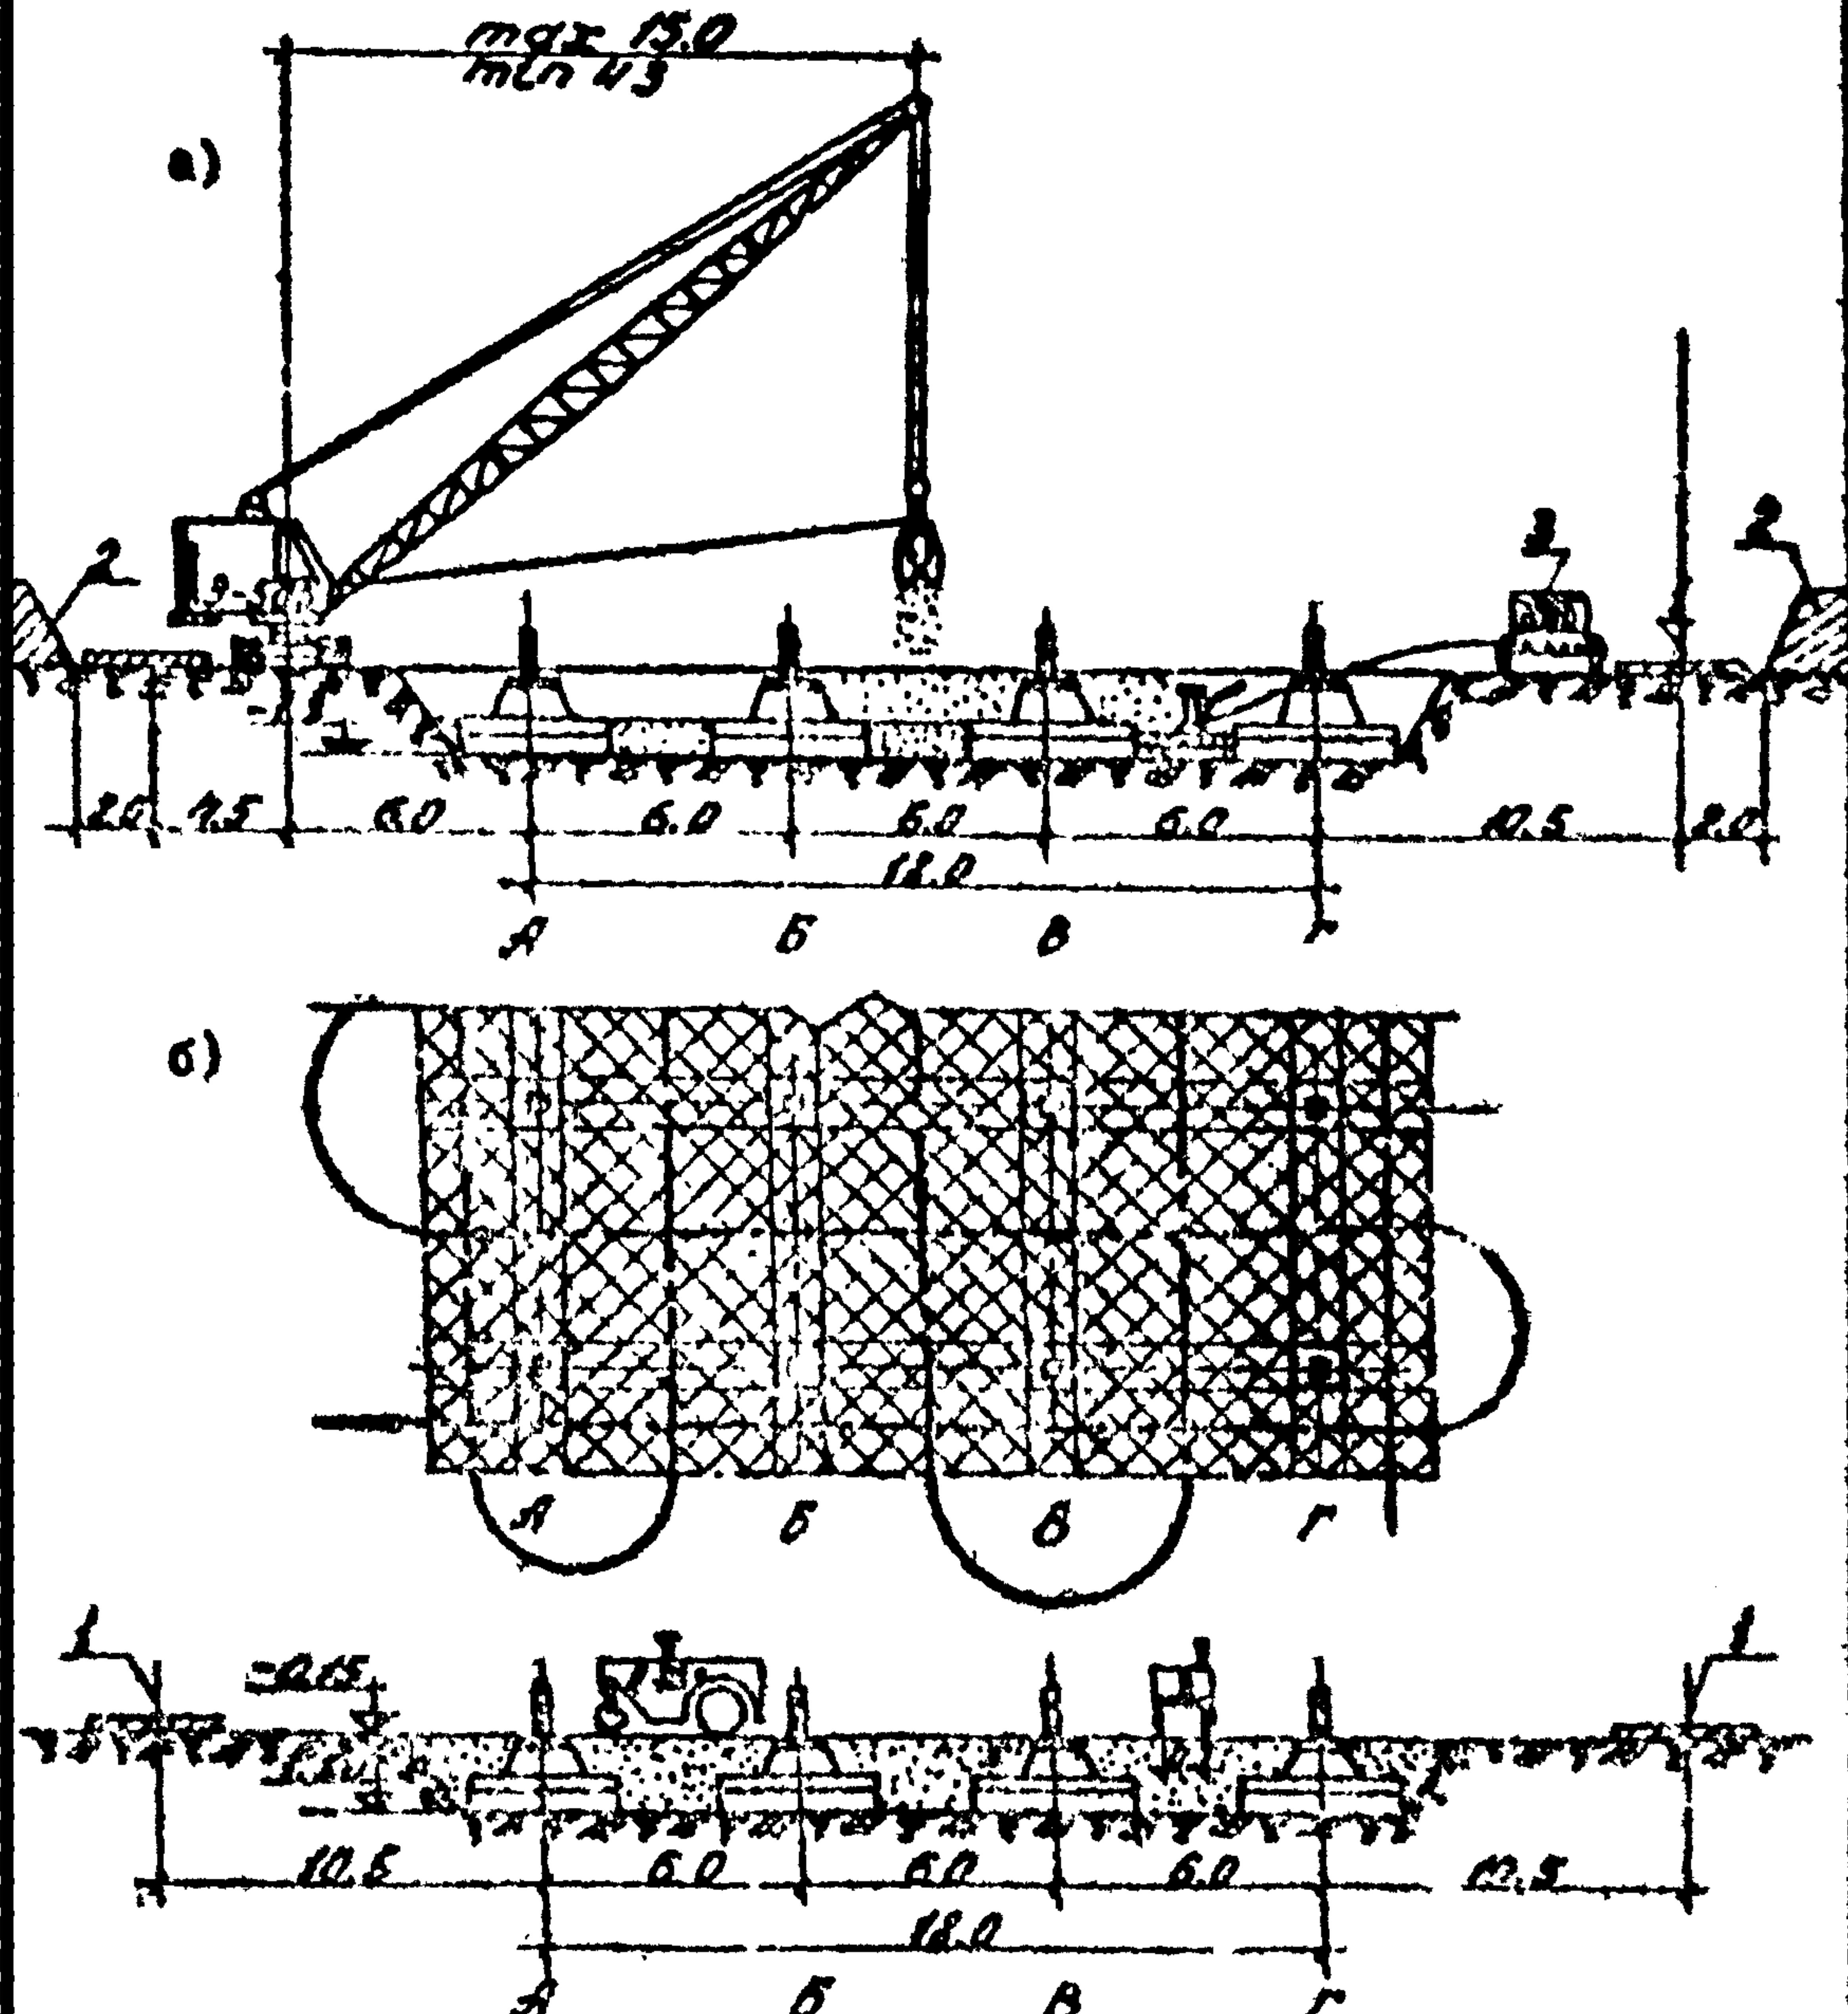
Рис. I. Схема организации работ при обратной засыпке и уплотнении грунта в котловане,
